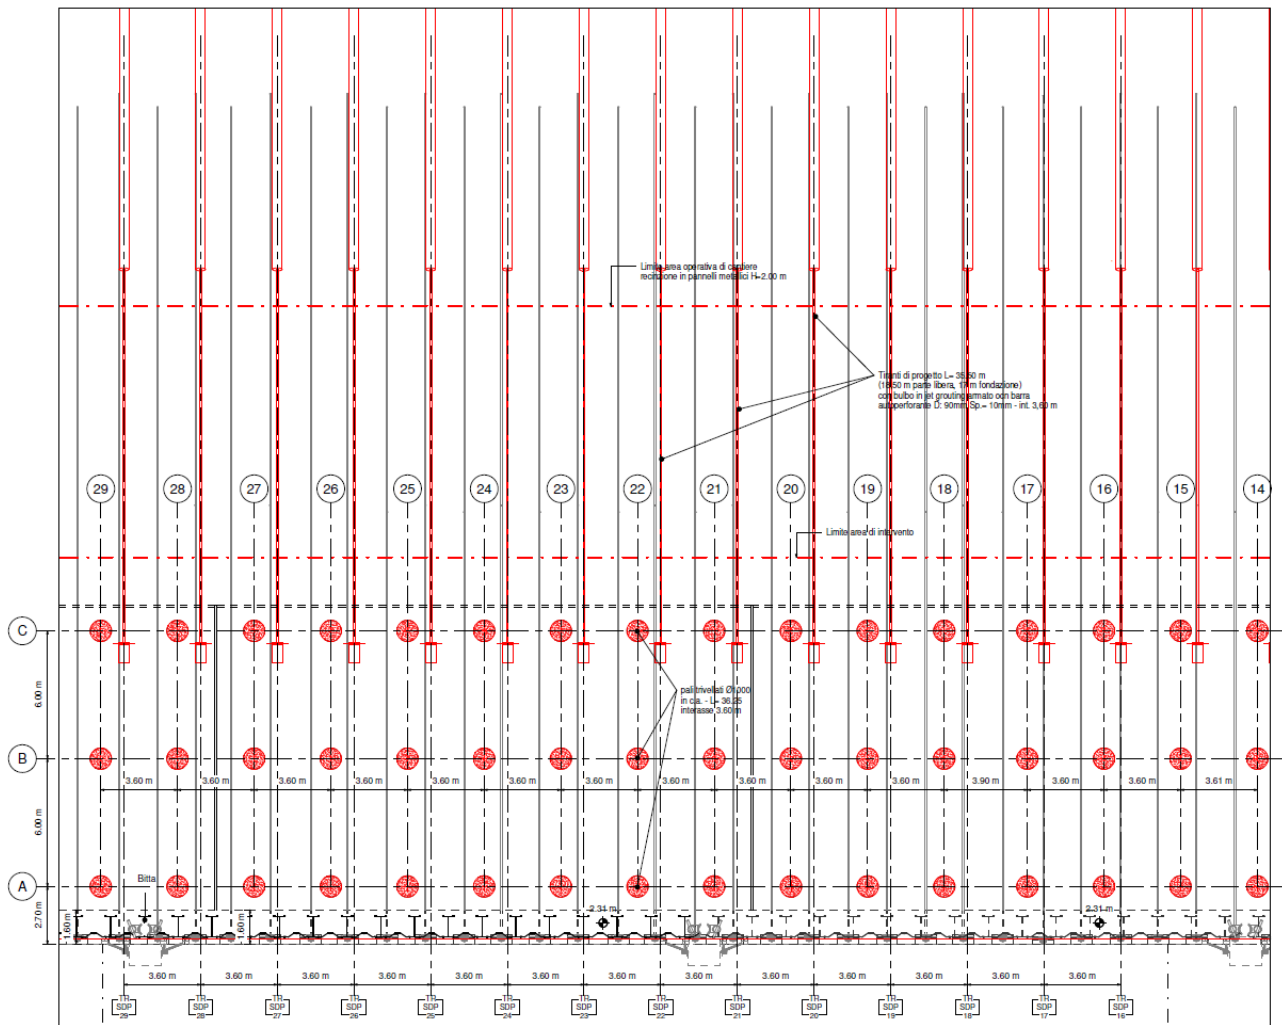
Stralcio opere strutturali da progetto esecutivo
